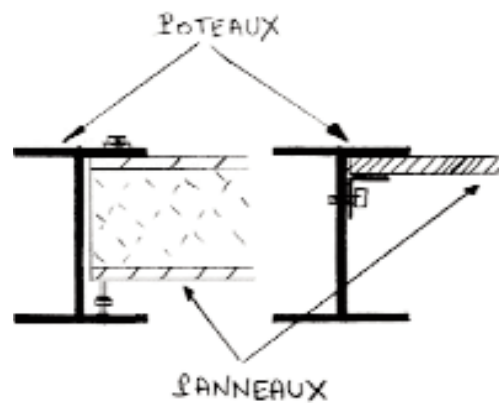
poteaux en profilés du commerce avec disposition courante du panneau
